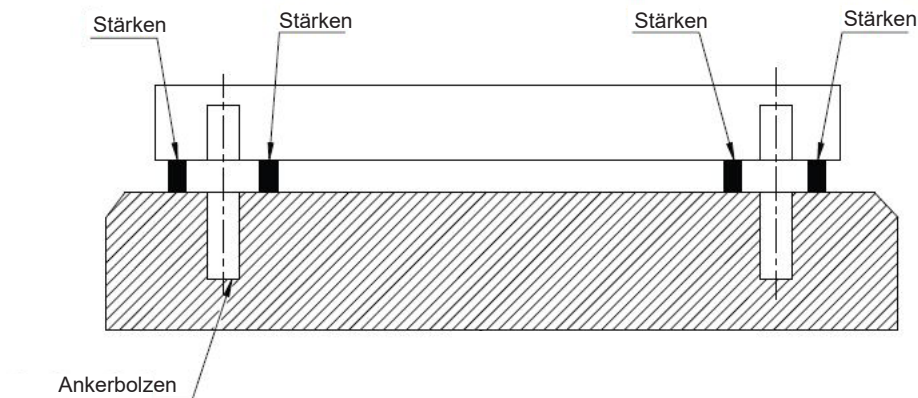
Anwendung Betonfundamente, Klinge und Verankerung
